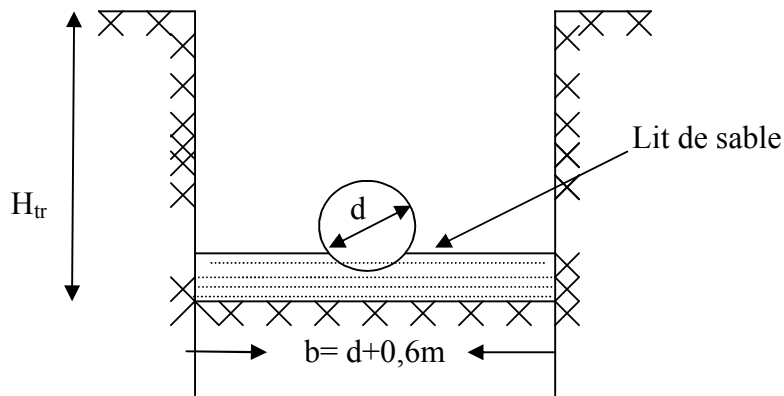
Schéma d'une tranchée avec pose de conduite
